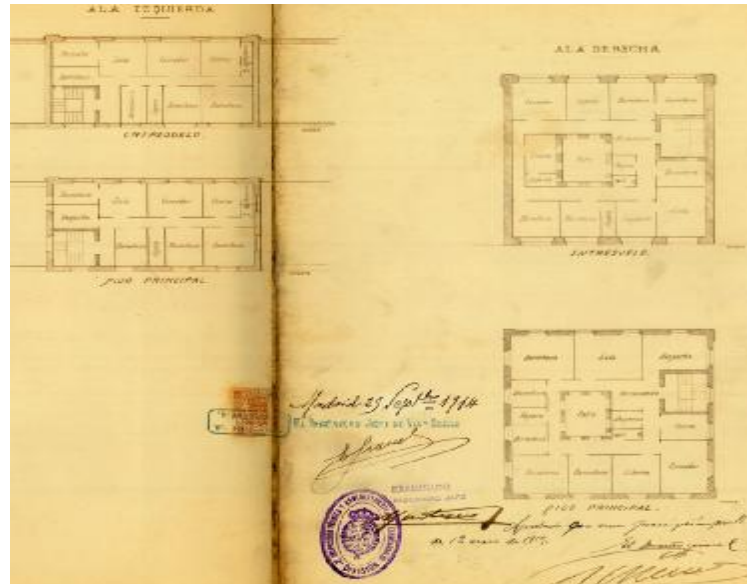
Entreplanta y planta alta alas izquierda y derecha. Estación de Valencia.. (FFE)- 2007).
